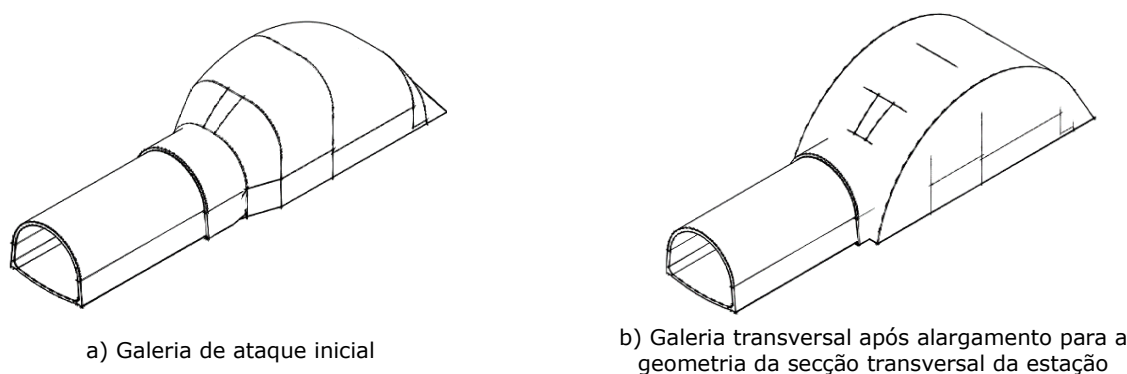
Imagens tridimensionais esquemáticas da galeria transversal de ataque em duas fases distintas do processo de escavação preconizado
